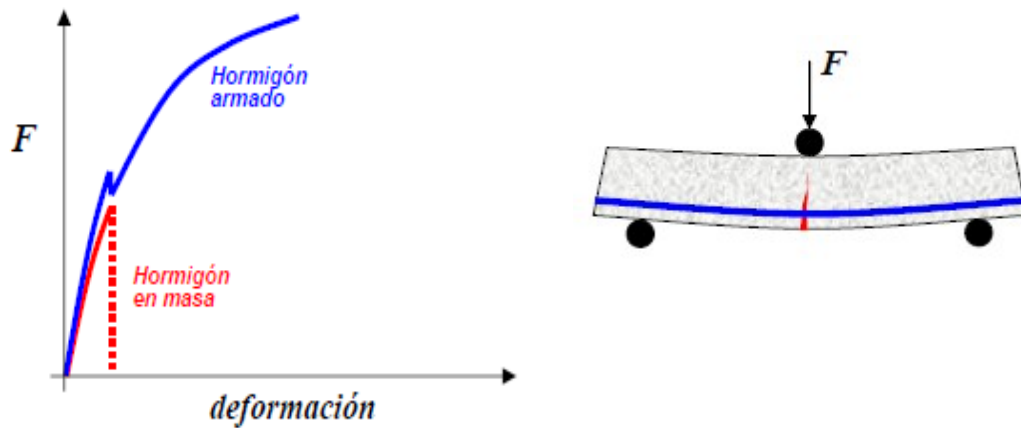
Comportamiento del Hormigón armado y Hormigón en masa.
